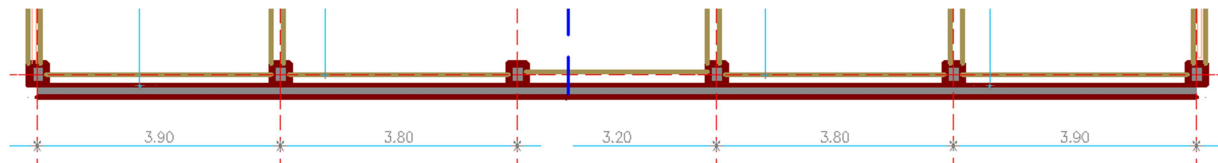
A : Schéma du mur plaque : Vue en plan
